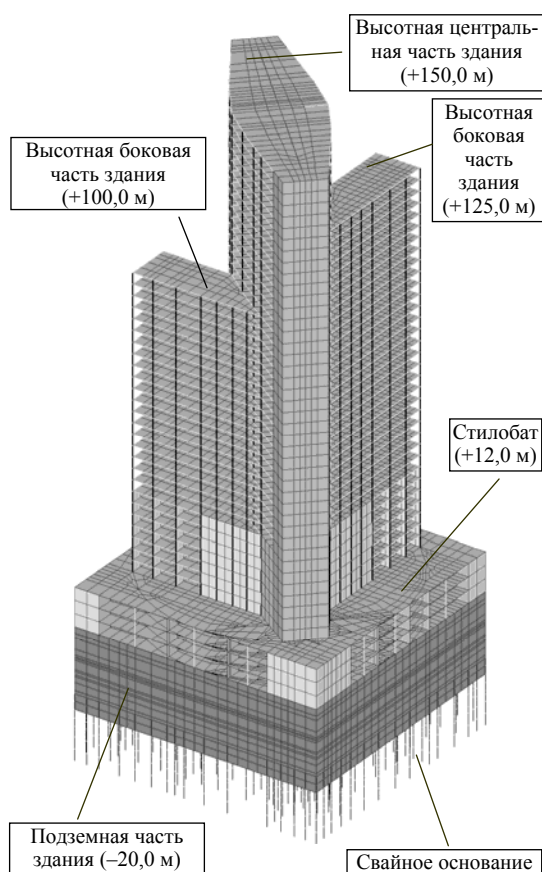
Фрагмент расчетной схемы. Конструкции высотного здания с подземной частью
